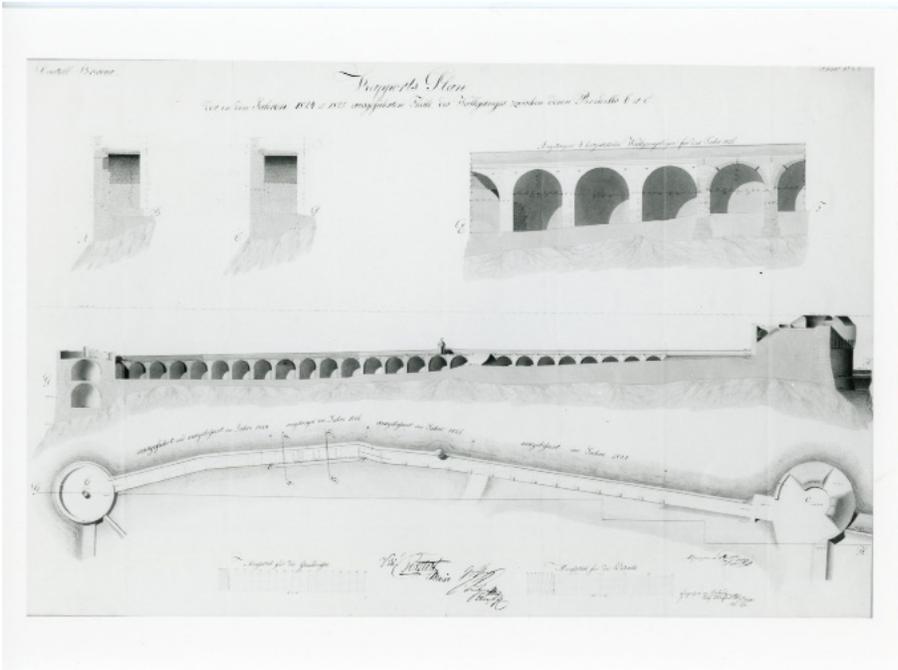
Pianta, prospetto e sezioni delle mura settentrionali del castello di Brescia realizzati per la ricostruzione di alcune arcate tra il 1824 e il 1826. Vienna, Kriegsarchiv (foto dall'archivio dell'autore)
